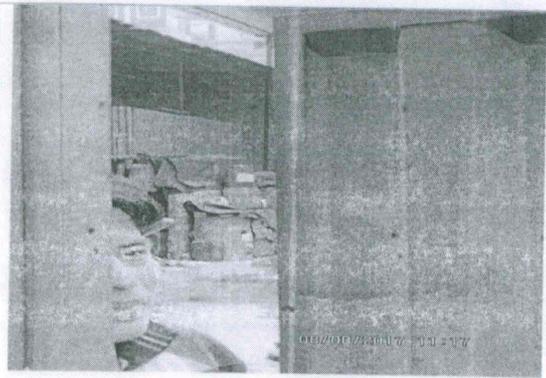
Vista del frente de la Planta San Juan de Lurigancho de LEATHER TECHIN S.A , donde se observa la puerta de ingreso al establecimiento industrial del administrado.
